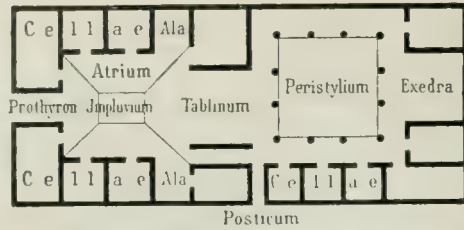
Grundriss eines pompejanischen Wohnhauses. (Nach H. Mau, Führer durch Pompeji; zu S. 117)
